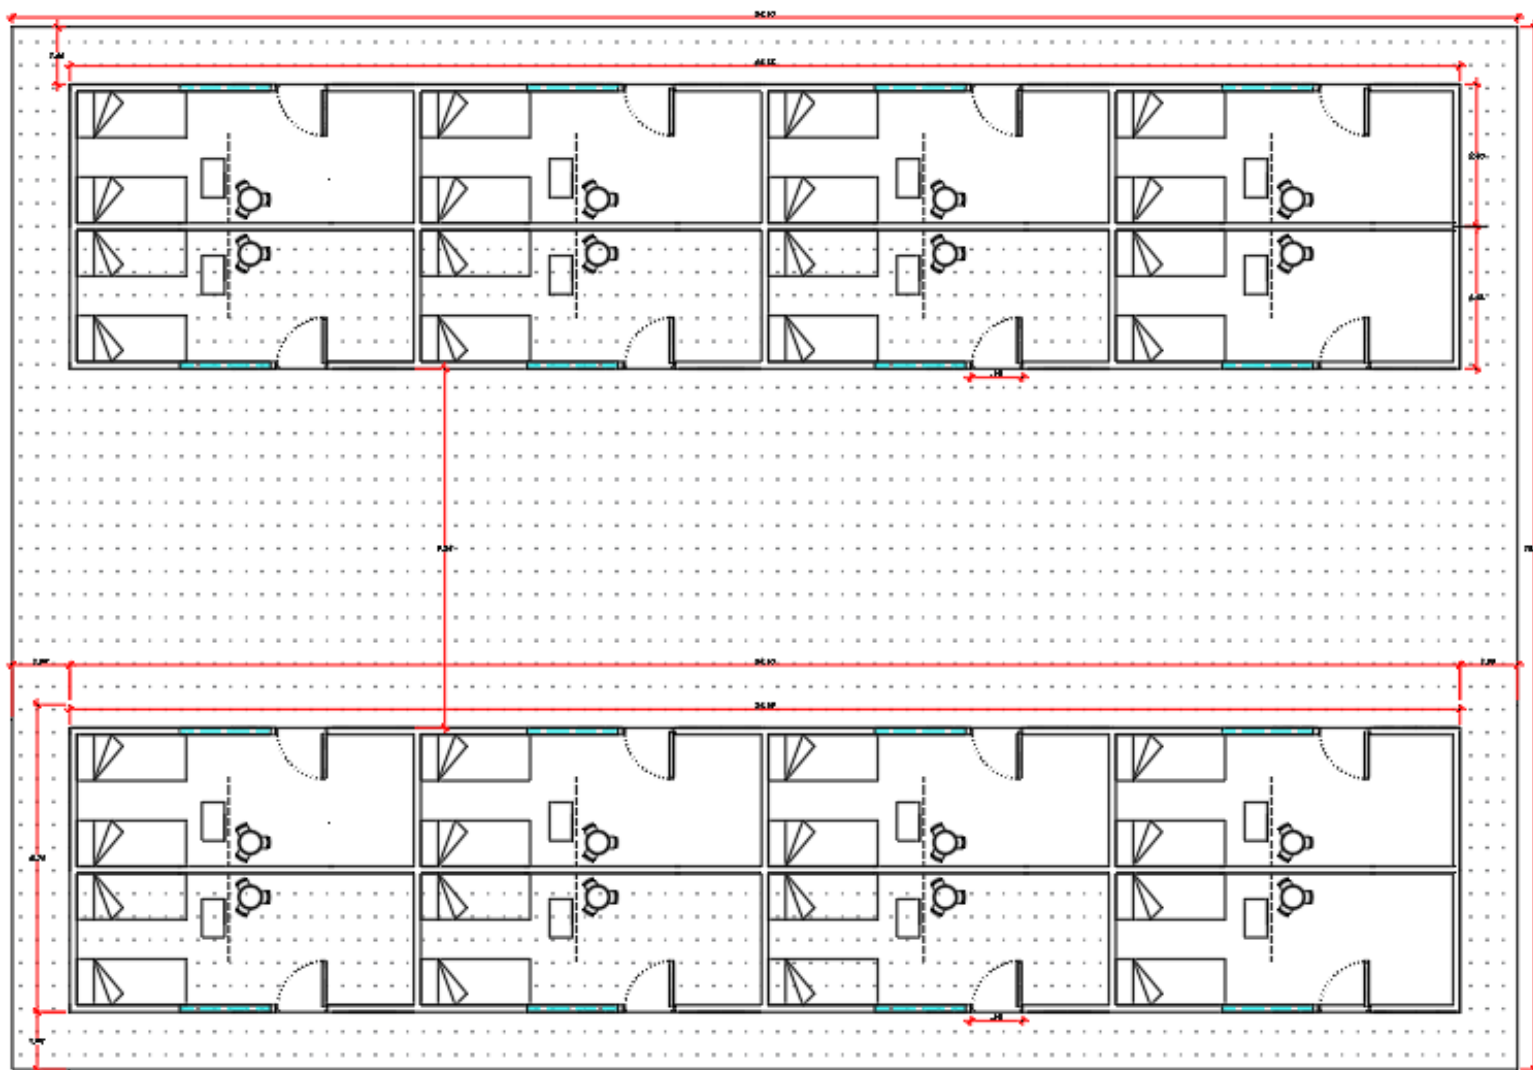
Plano de viviendas de tipología A: Elaboración propia.
